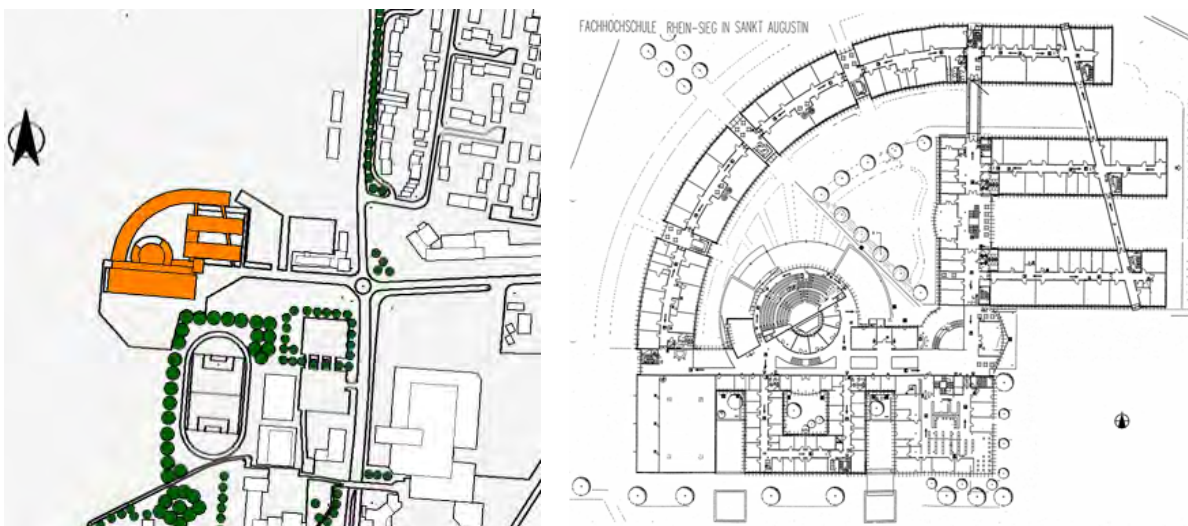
Planimetria generale e pianta piano terra. - fonte delle immagini Euleb
